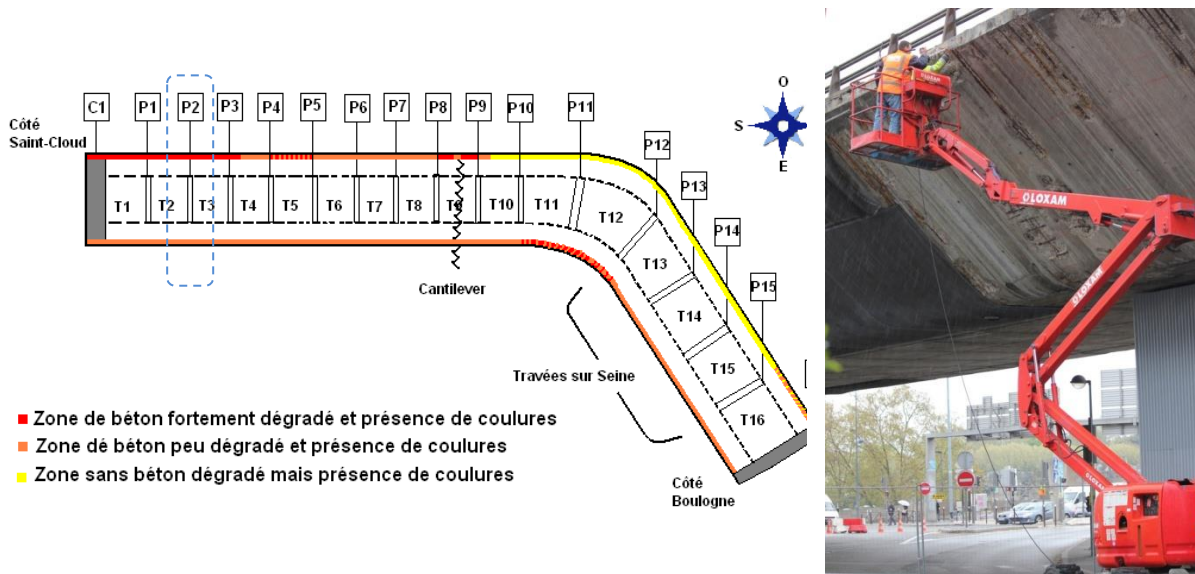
La pile P2 a fait l'objet du chantier pilote.
